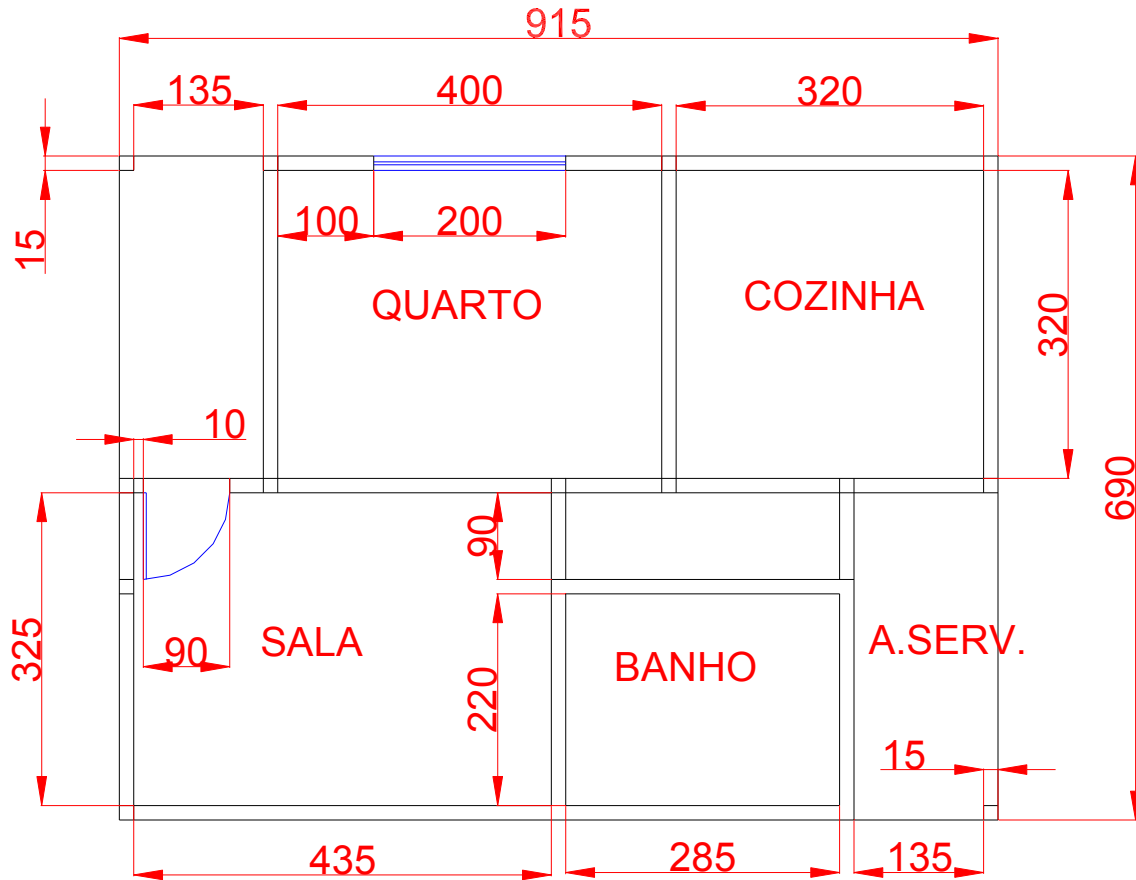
Ilustração de uma planta baixa semi-acabada
